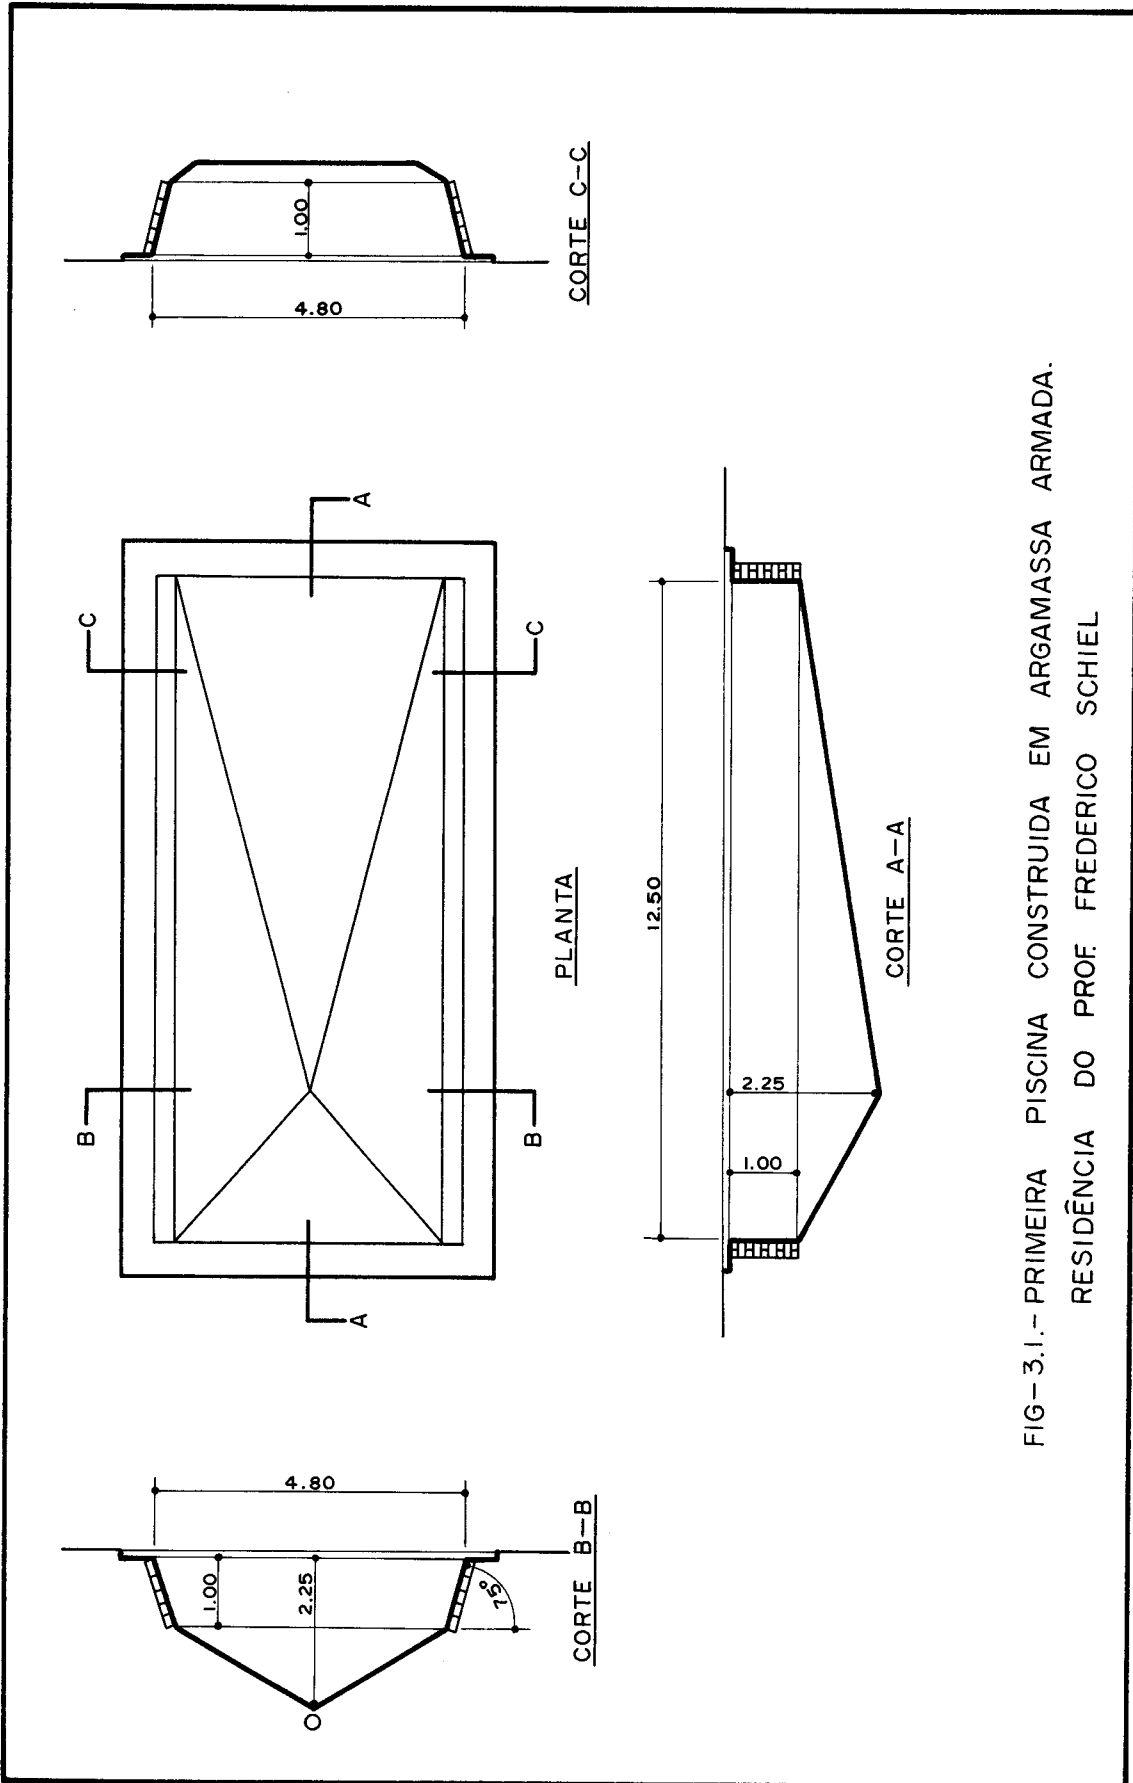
PRIMEIRA PISCINA CONSTRUIDA EM ARGAMASSA ARMADA.
